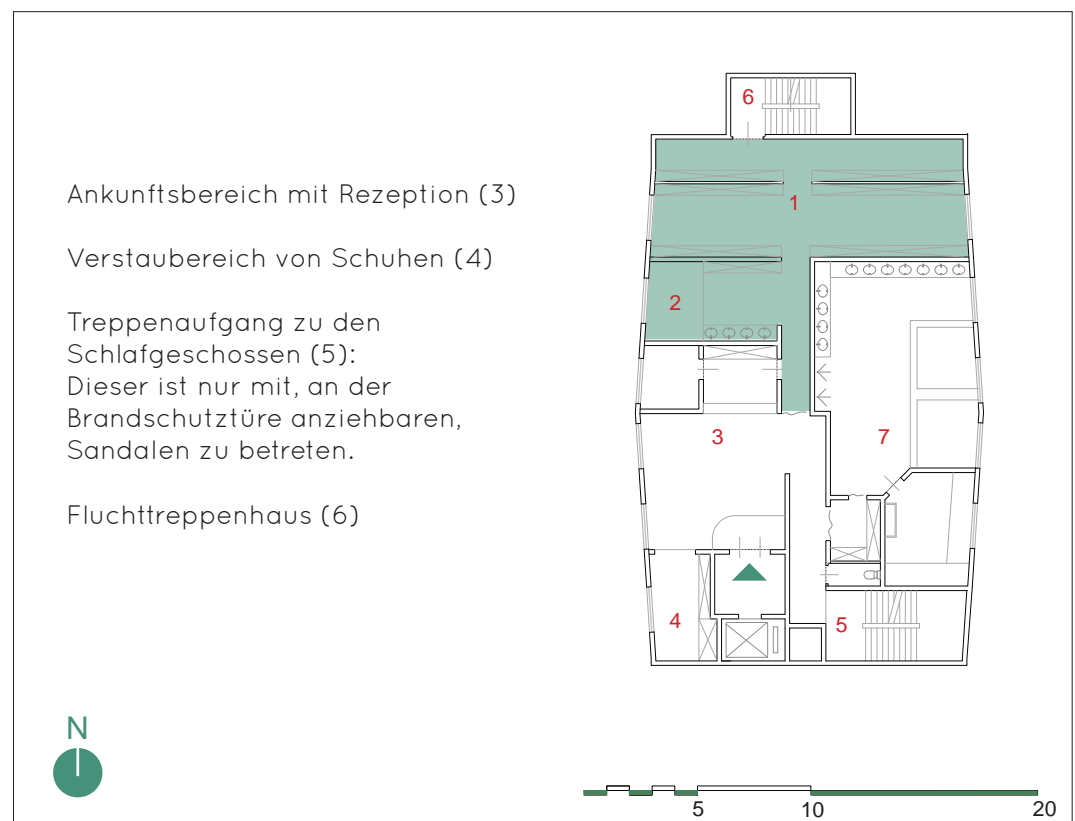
Hotelgrundriss - Sauna und Orient Hotel - OG 1
